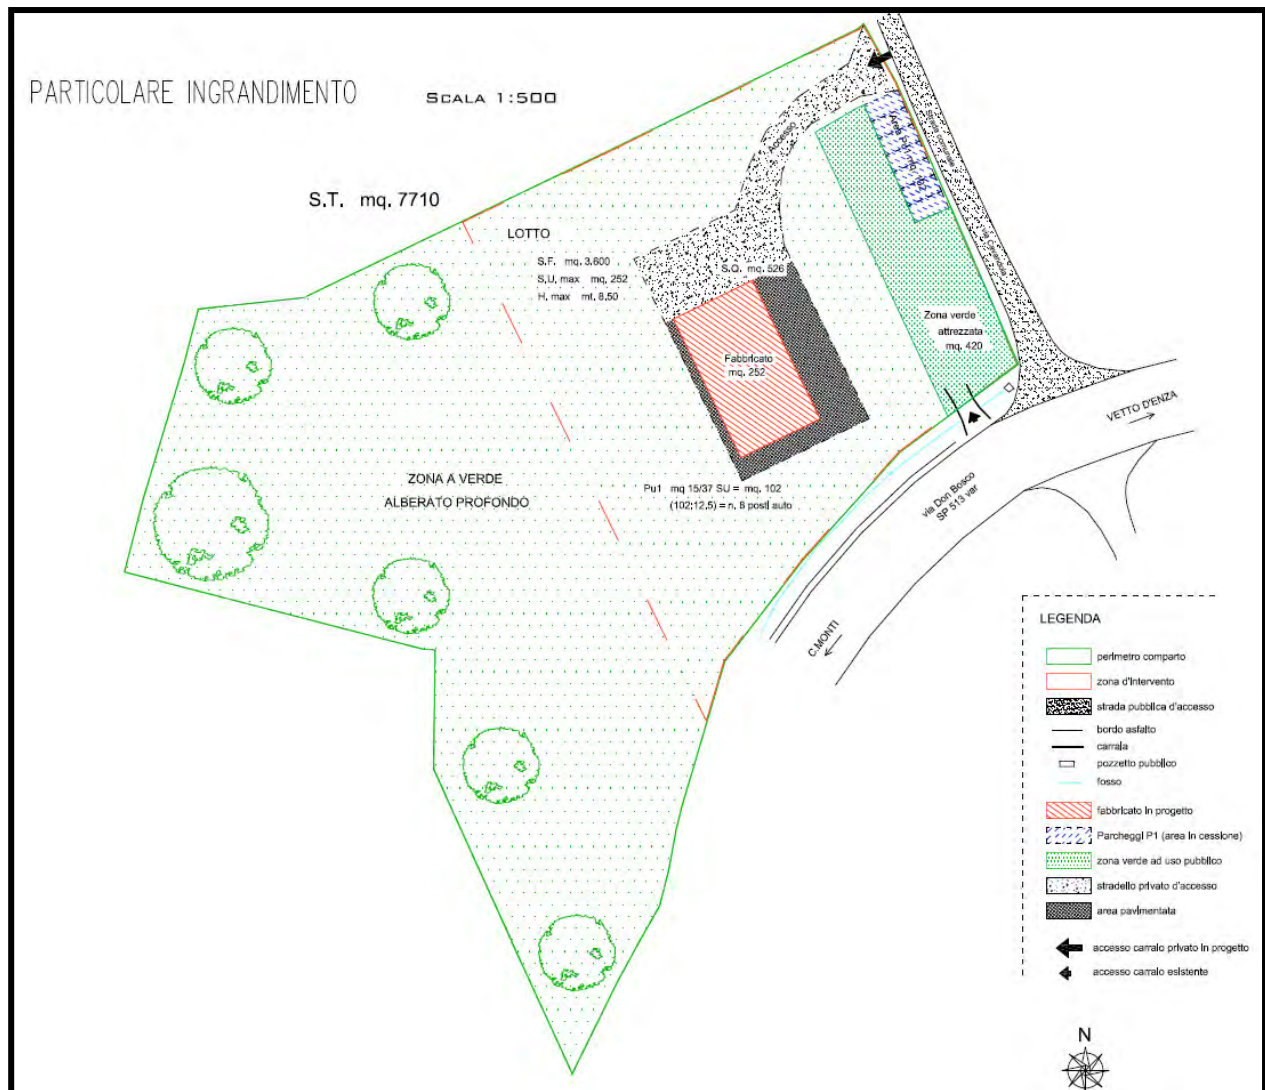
estratto della planimetria dell'area con indicazione del progetto proposto
